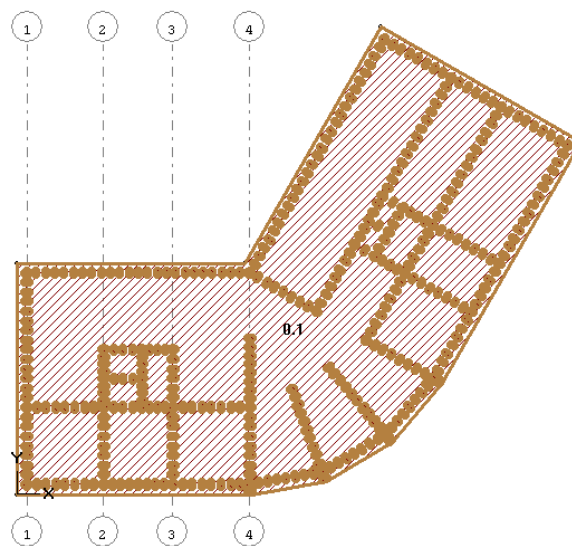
Фундаментная плита №1_1 с нагрузками
